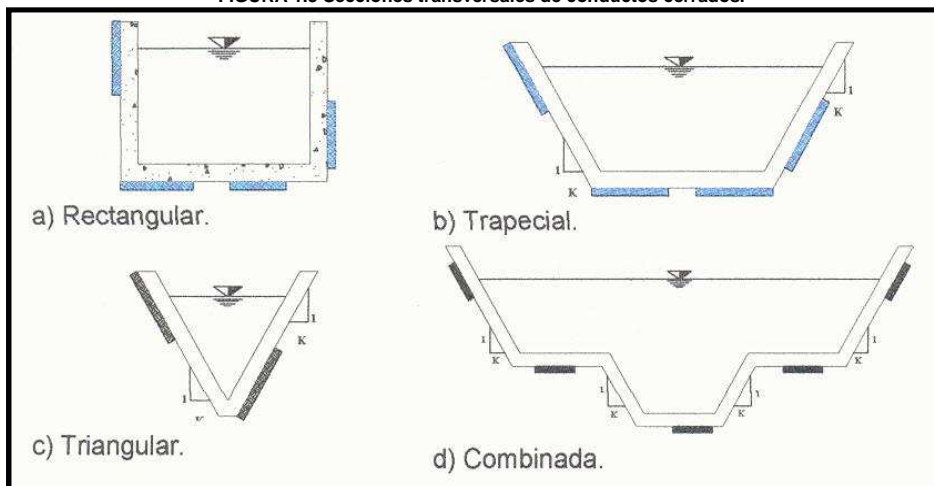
Secciones transversales de conductos a cielo abierto
